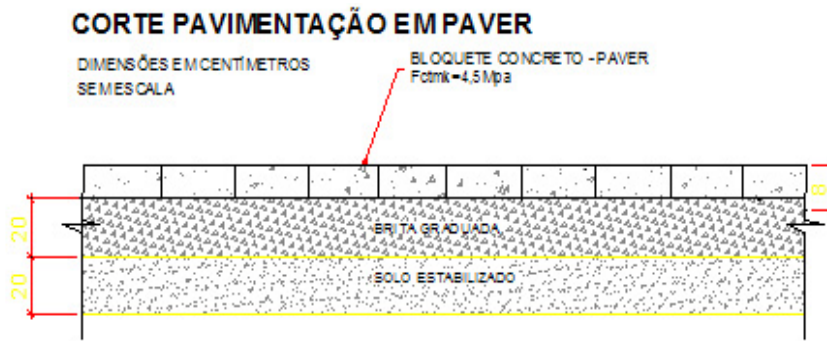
Corte da pavimentação em bloco de concreto intertravado (bloquete ou “paver”) dos pátios.
